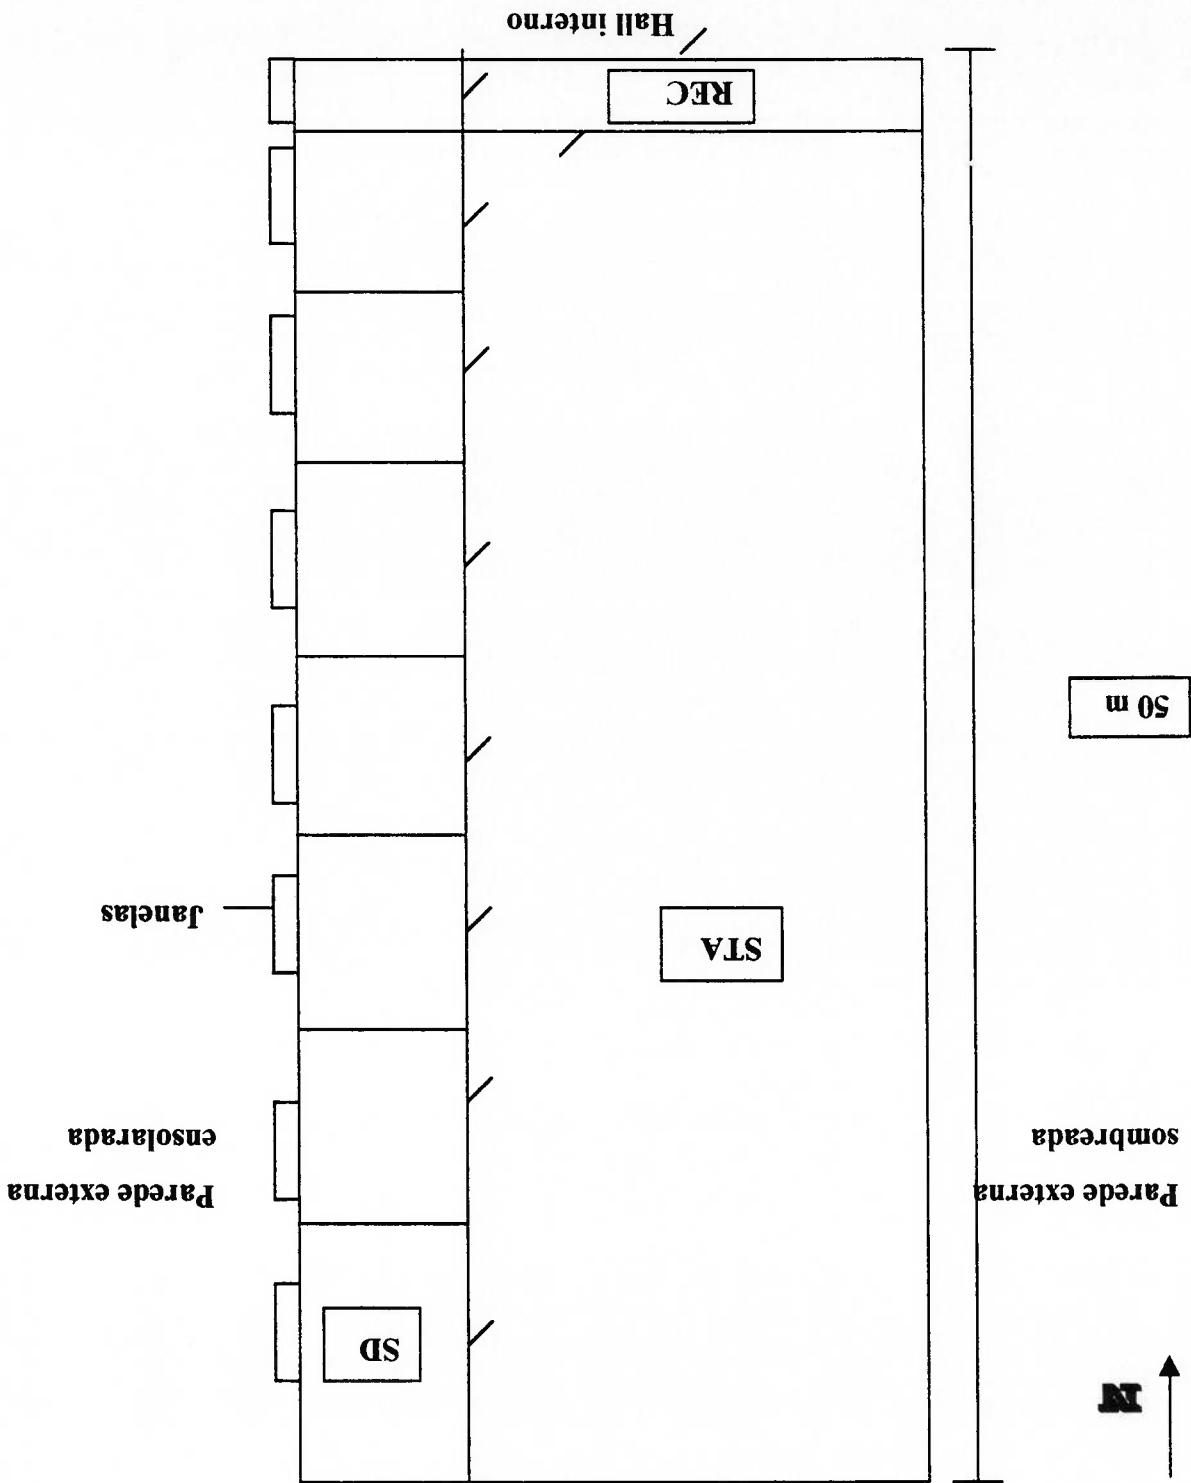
Planta baixa dos ambientes a condicionar.
